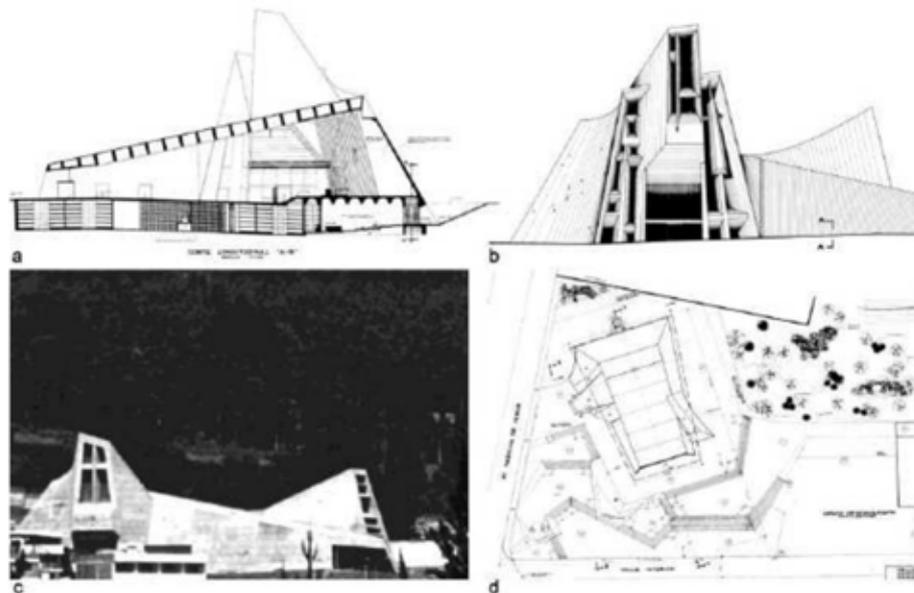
Templo de la Dolorosa. a) Sección longitudinal b) Alzado de la torre Sur c) Fotografía desde la Avenida América d) Plano de implantación⁶
